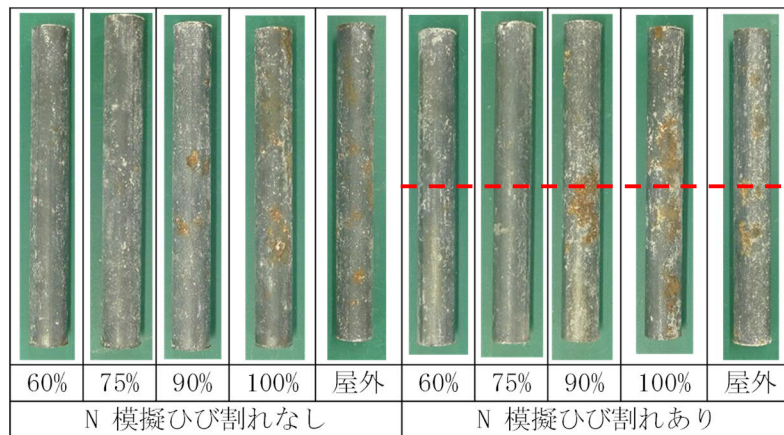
暴露試験期間終了時の鉄筋腐食状況（N／模擬ひび割れなし，あり）
